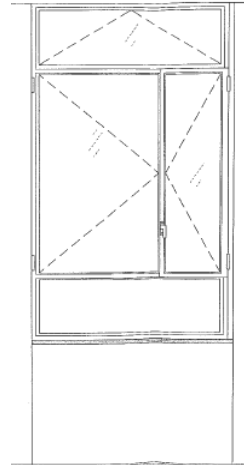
Fachada Norte. Vidrio simple Biblioteca.
